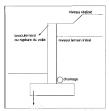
· Surcharges non prévues sur un mur de souténement.
